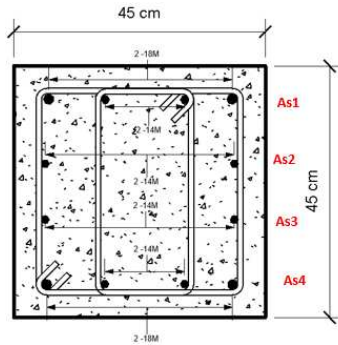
Armado de refuerzo de la columna (SMF) del sistema de 6 Pisos
